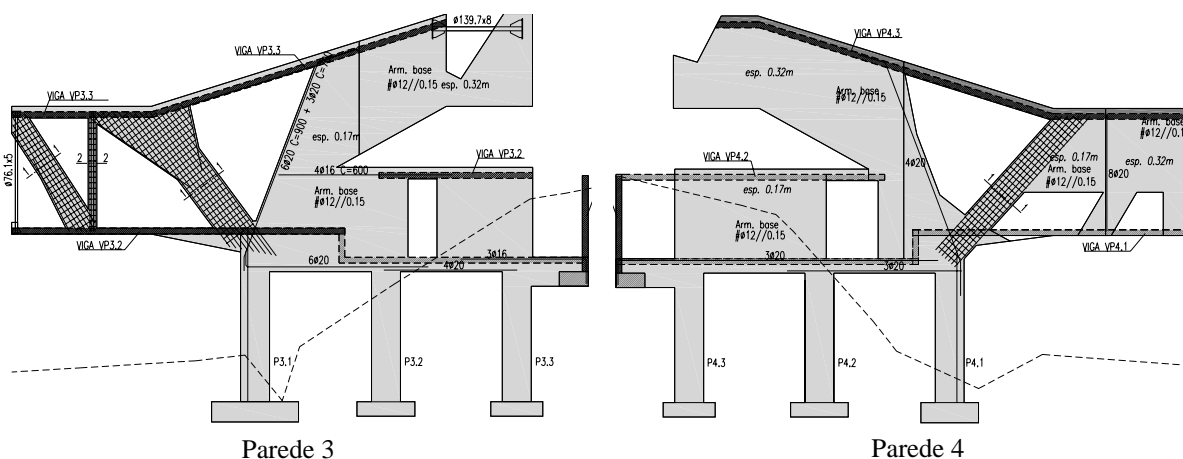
Disposição das armaduras nos elementos estruturais verticais.
